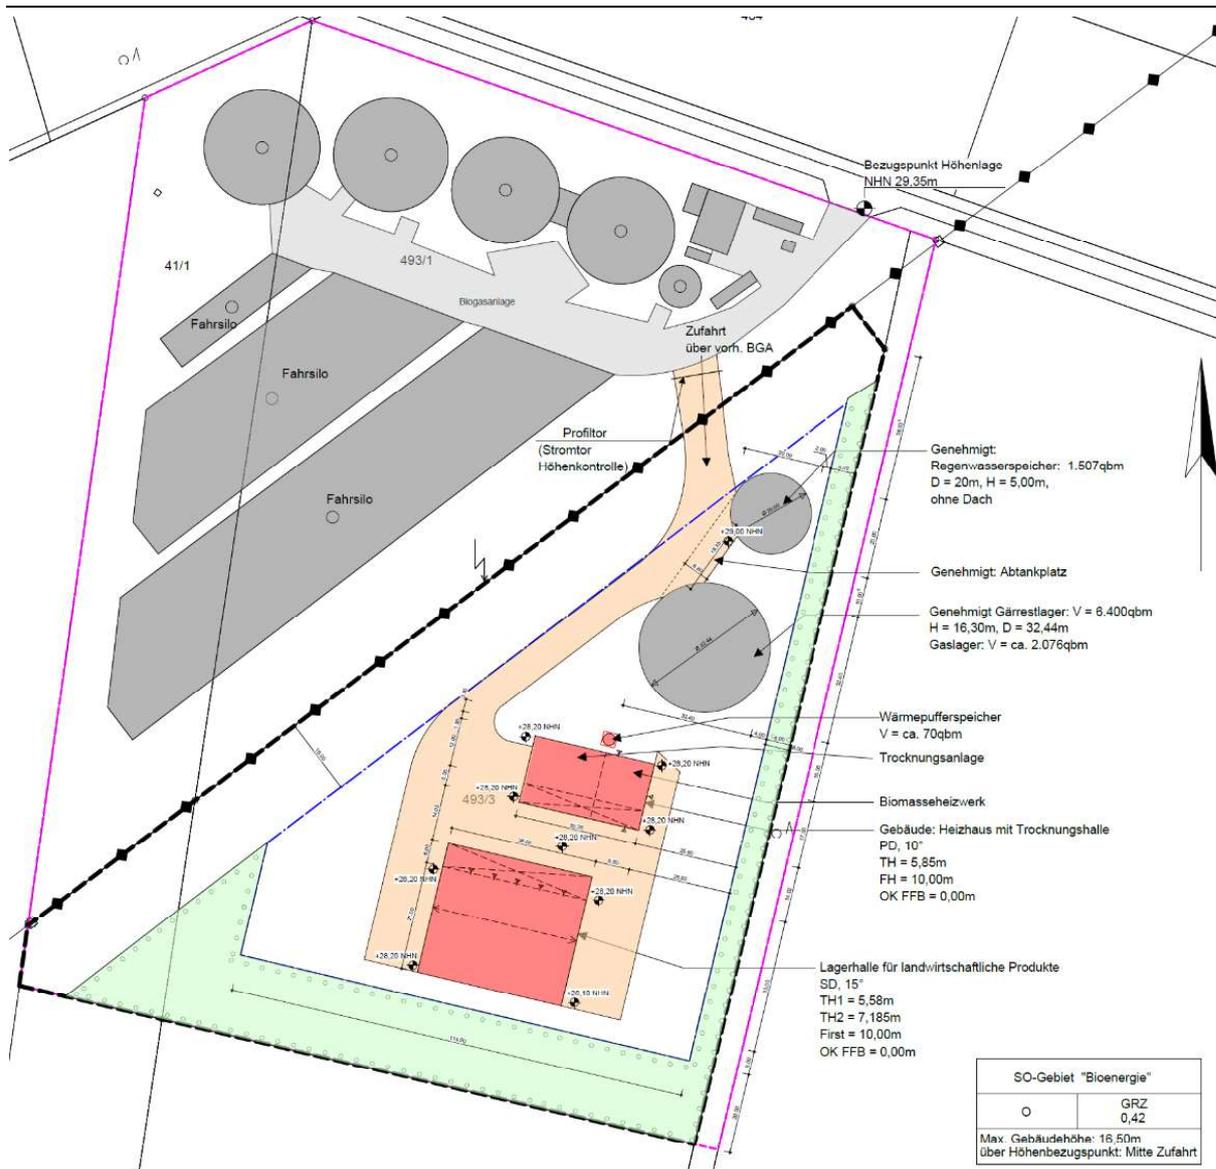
Entwurfslageplan Bau Holzhackschnitzelheizung mit dazugehöriger Lagerhalle<sup>53</sup>
